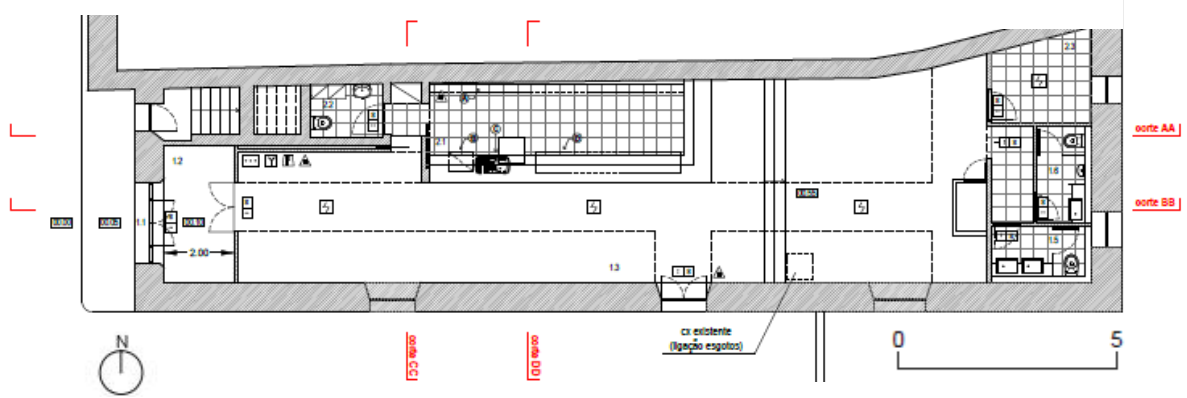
Planta da proposta - Esc. 1/200 – Autora do projeto
